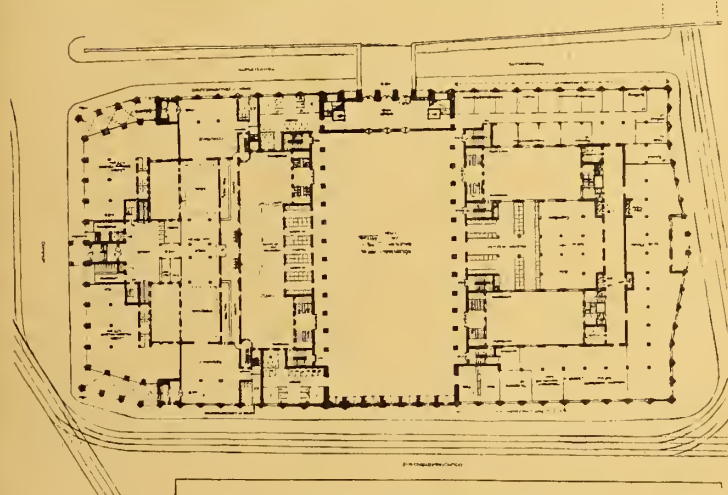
Grundriß des Hauptgeschosses. Erster Preis.
